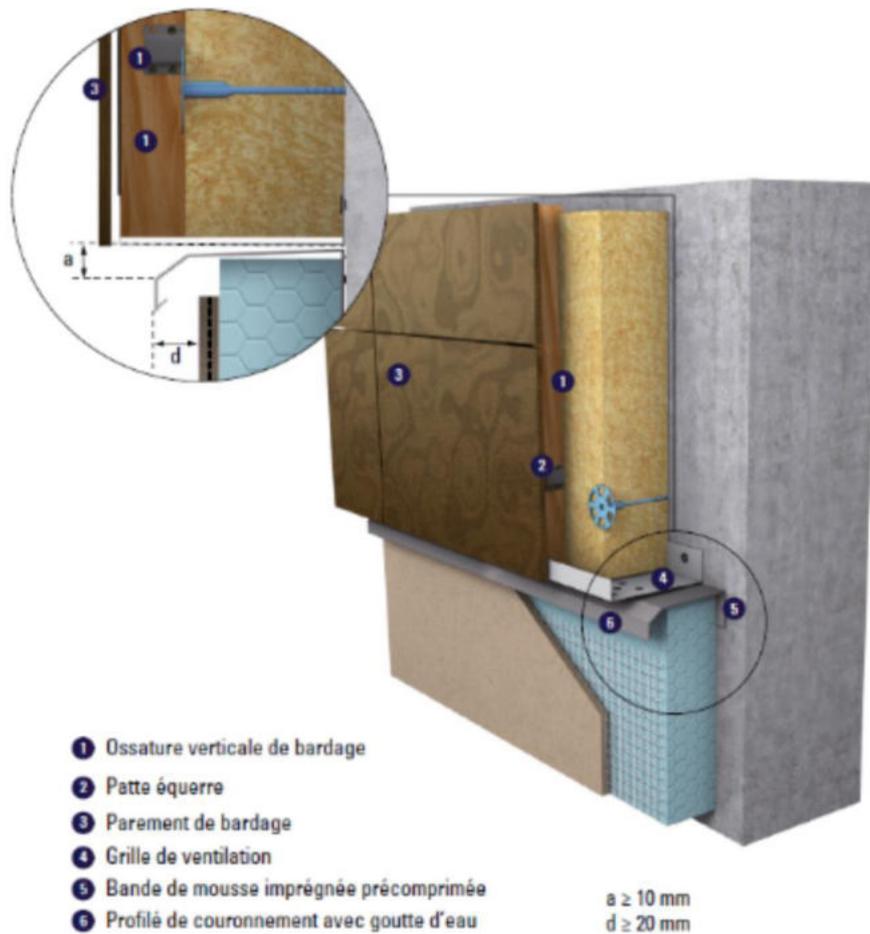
Jonction avec procédé d'enduit sur isolant – coupe verticale – enduit sur isolant en partie basse
